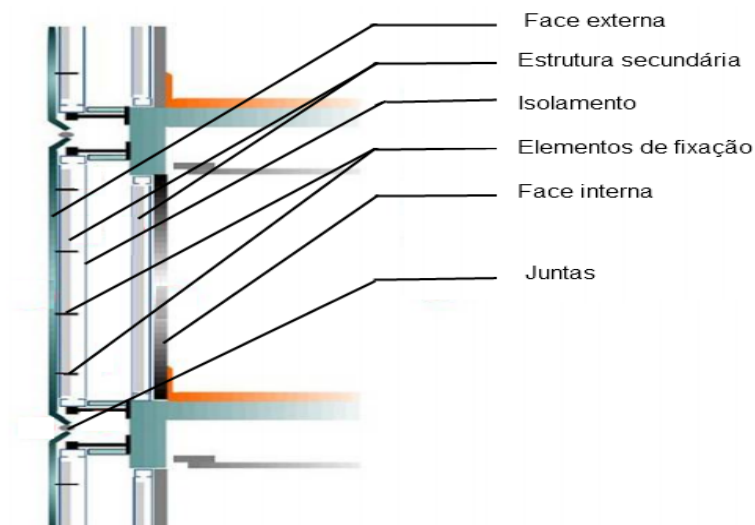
Esquema de corte longitudinal de uma fachada leve. Adaptado de [7].
